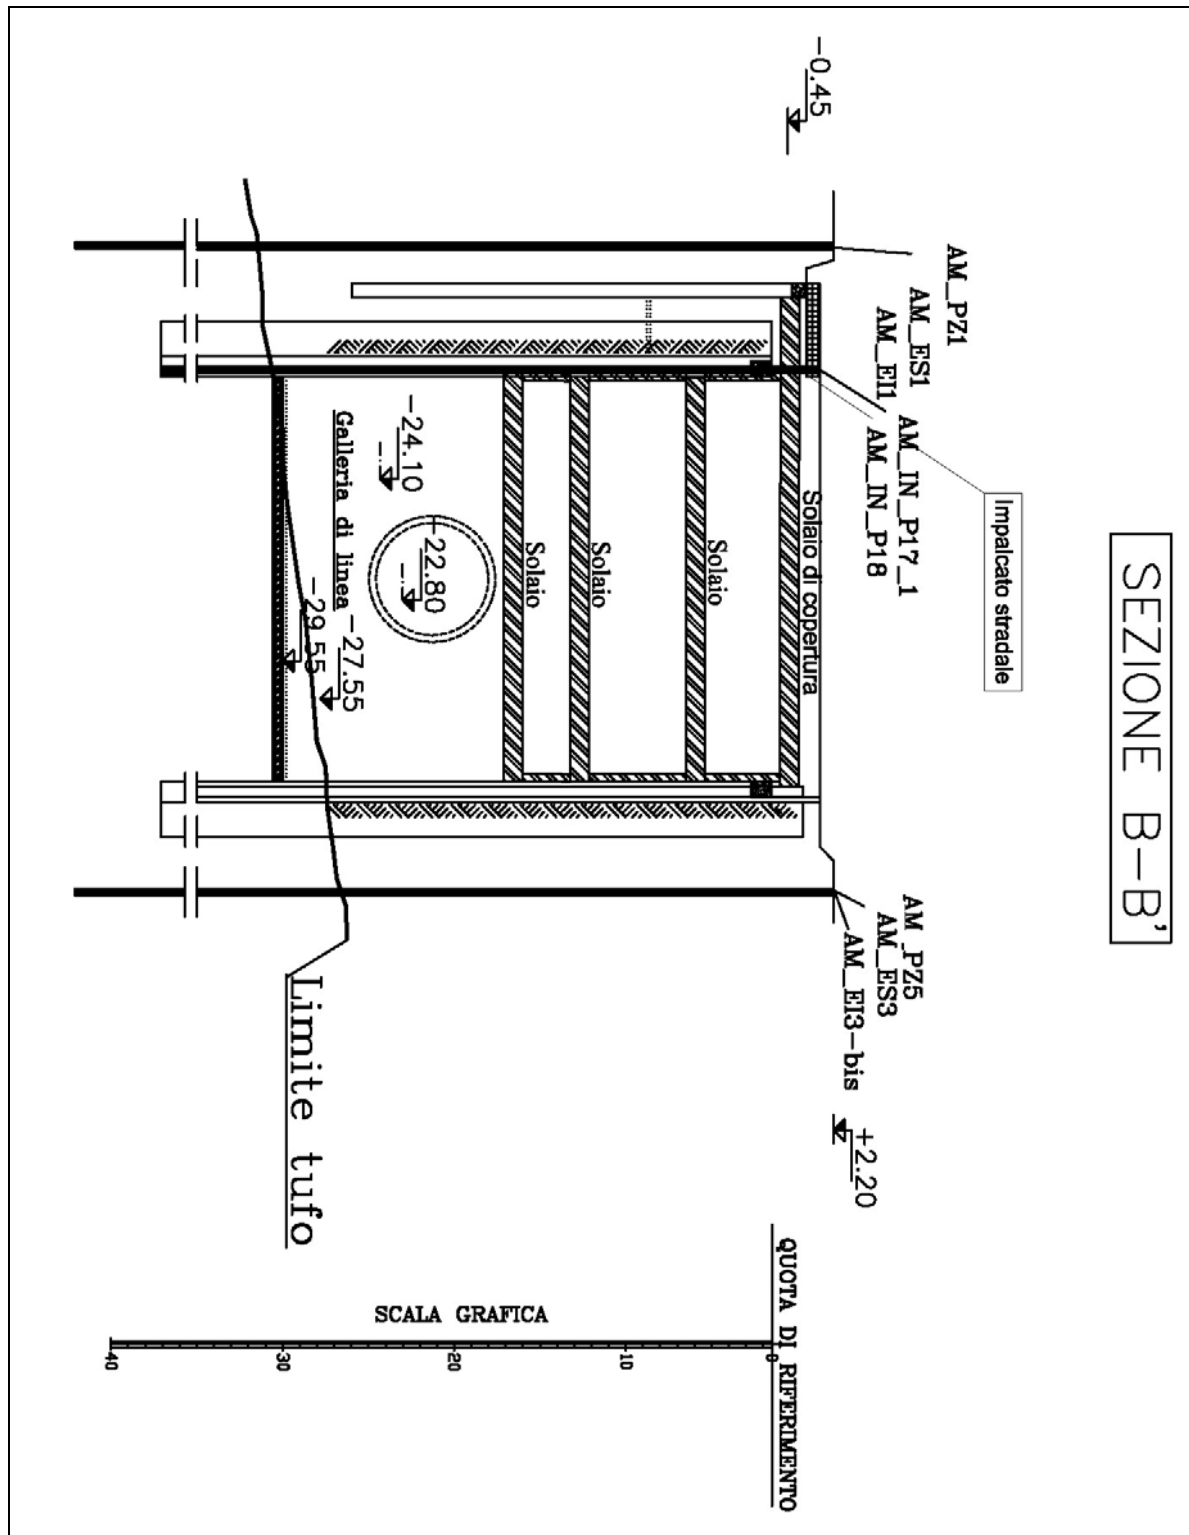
Sezione B-B' pozzo stazione, raffigurante la suddivisione in aree di lavoro.
